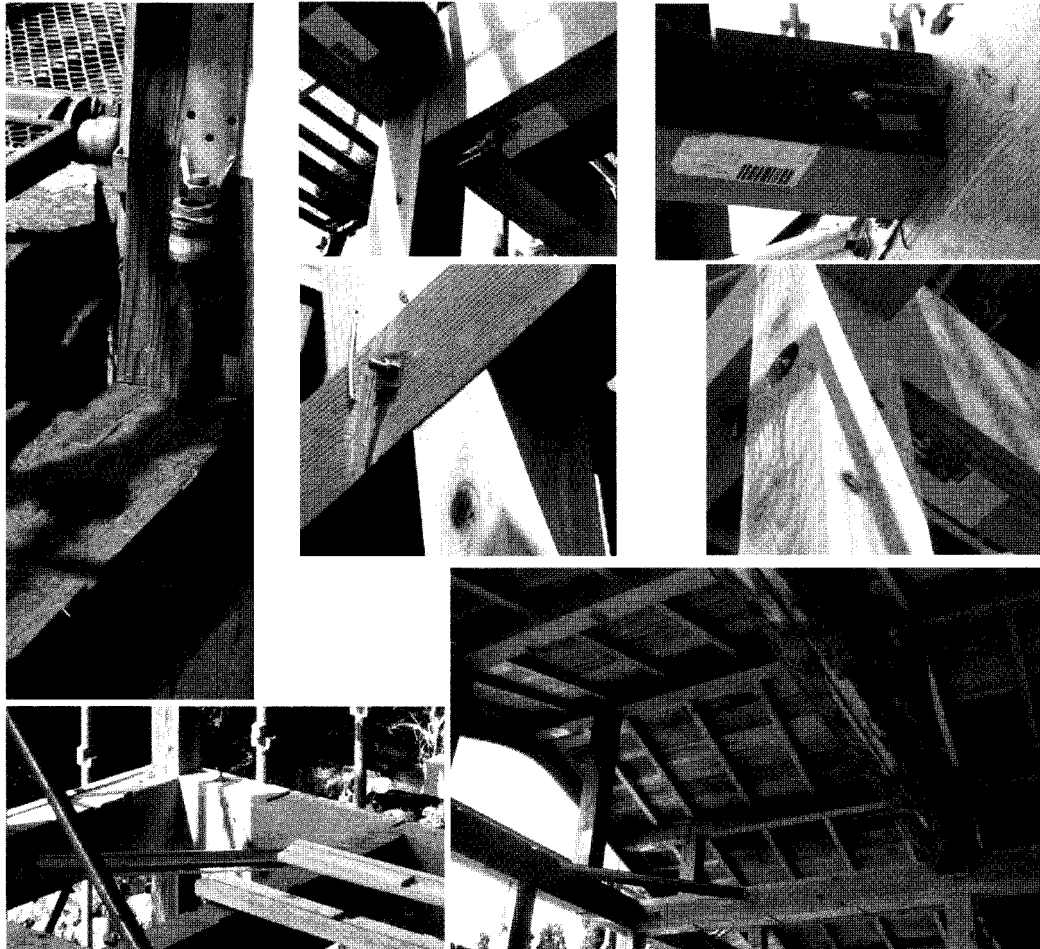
Chantier 1, détails du plancher les assemblages et ancrages des murs planchers et charpente
